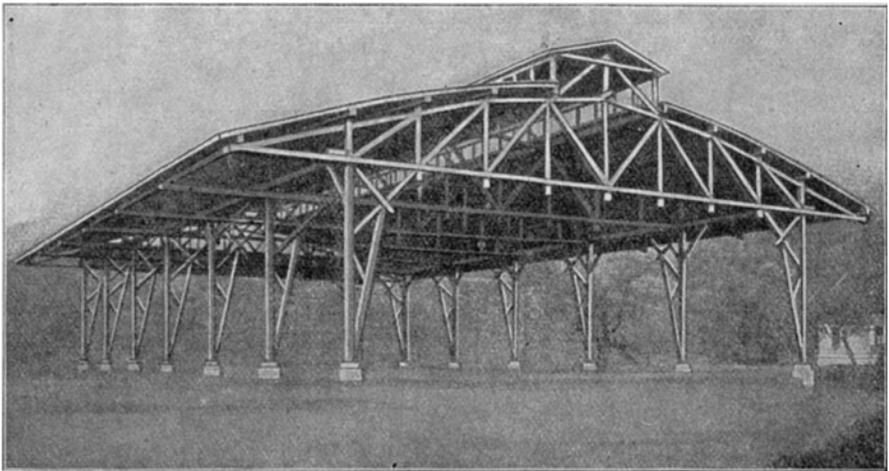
Offene Halle in fachwerkartiger Rahmenausbildung.
